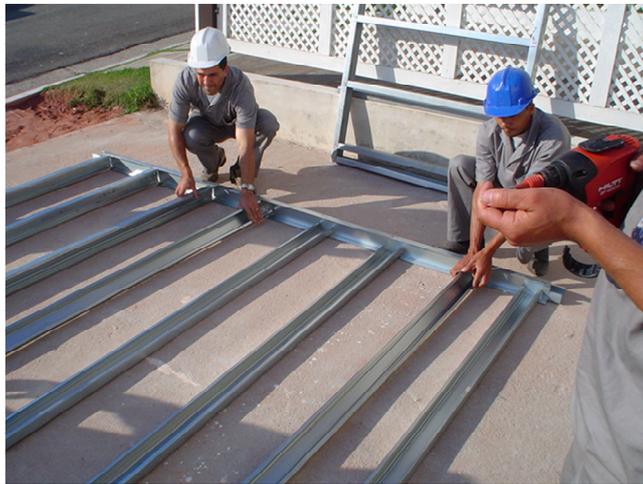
Montagem de painel em LSF no canteiro de obras
